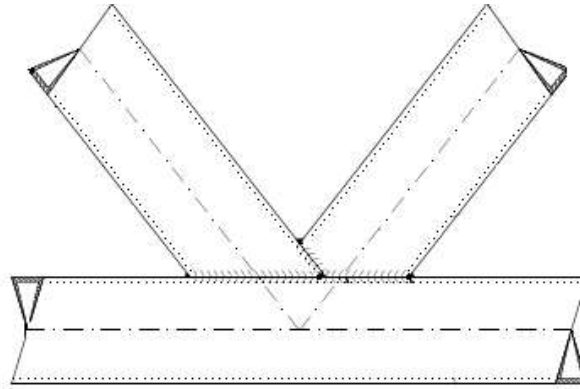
Unión soldada de perfiles tubulares cuadrados [3].
